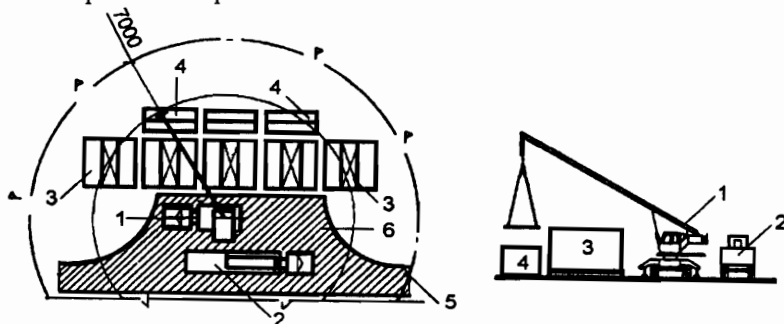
Технологическая схема разгрузки сборных железобетонных элементов самоходным стреловым краном: 1 – кран; 2 – автотранспорт; 3 – пирамиды для стеновых панелей; 4 – место складирования плит перекрытия; 5 – временная дорога; 6 – уширение дороги
